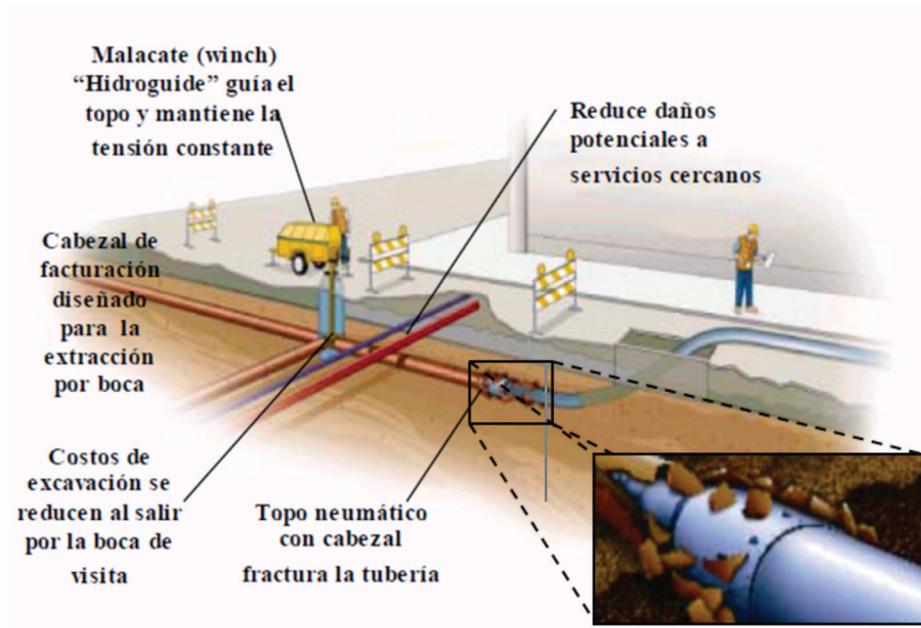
Proceso de fracturamiento (tubo a tubo)
